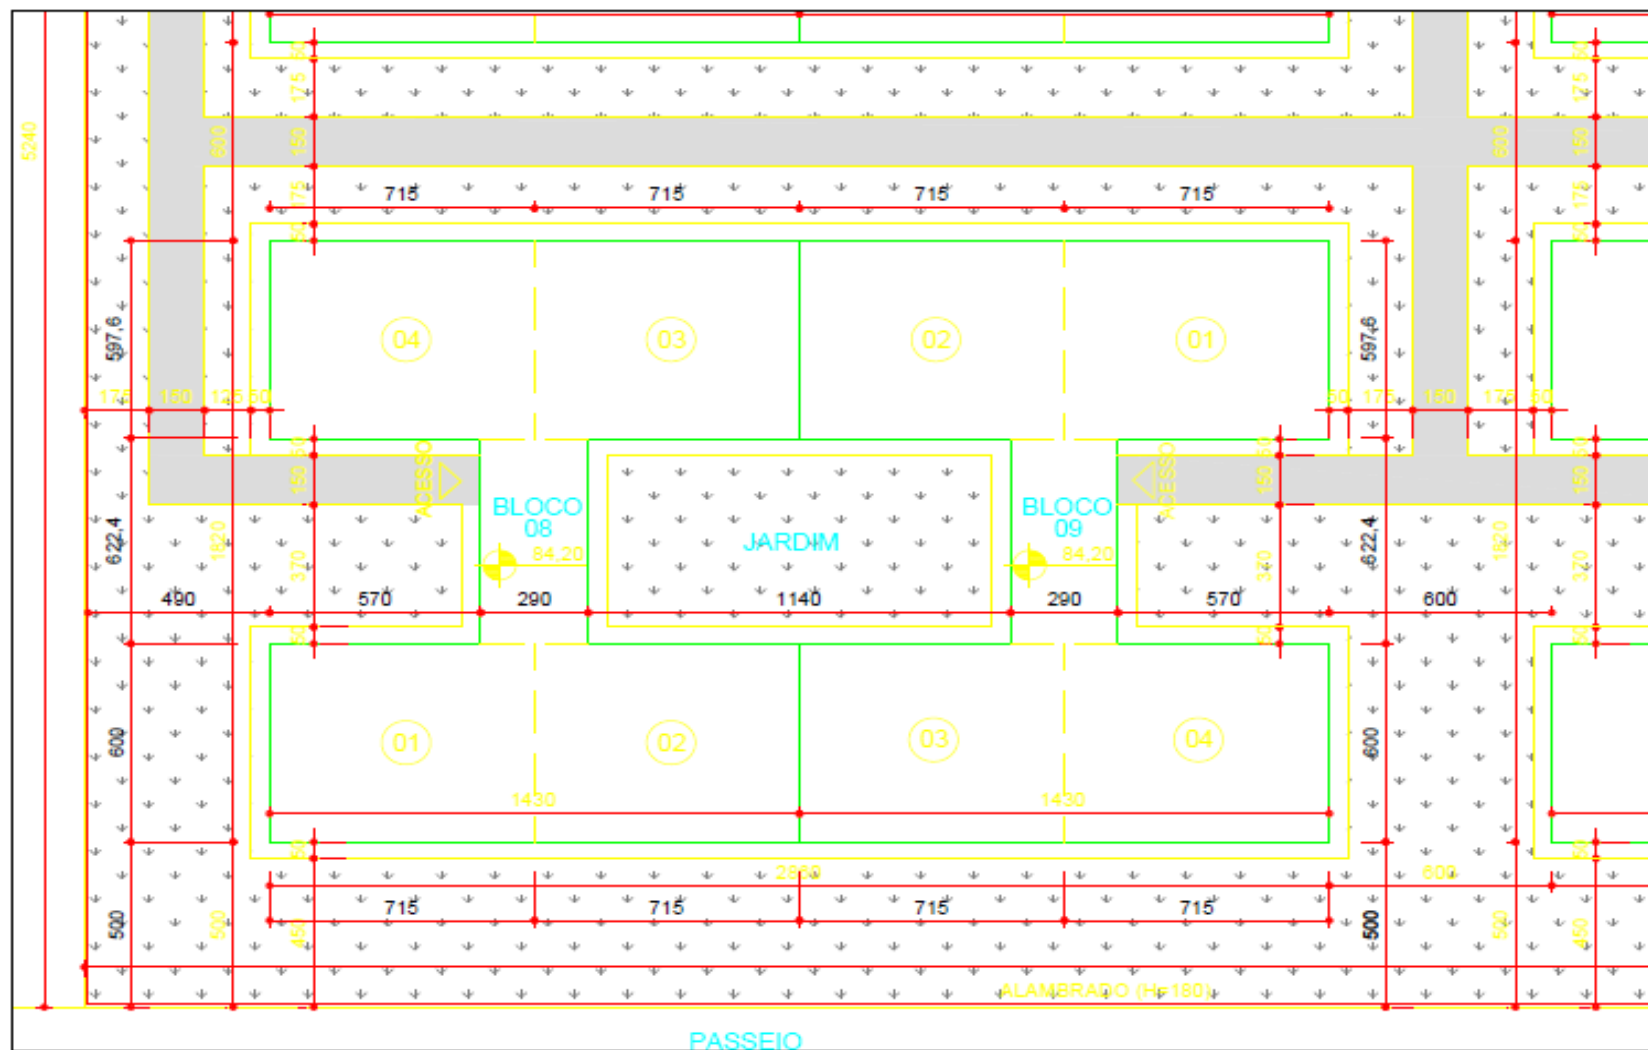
Planta de locação de um bloco de apartamentos. Fonte – SEAS
